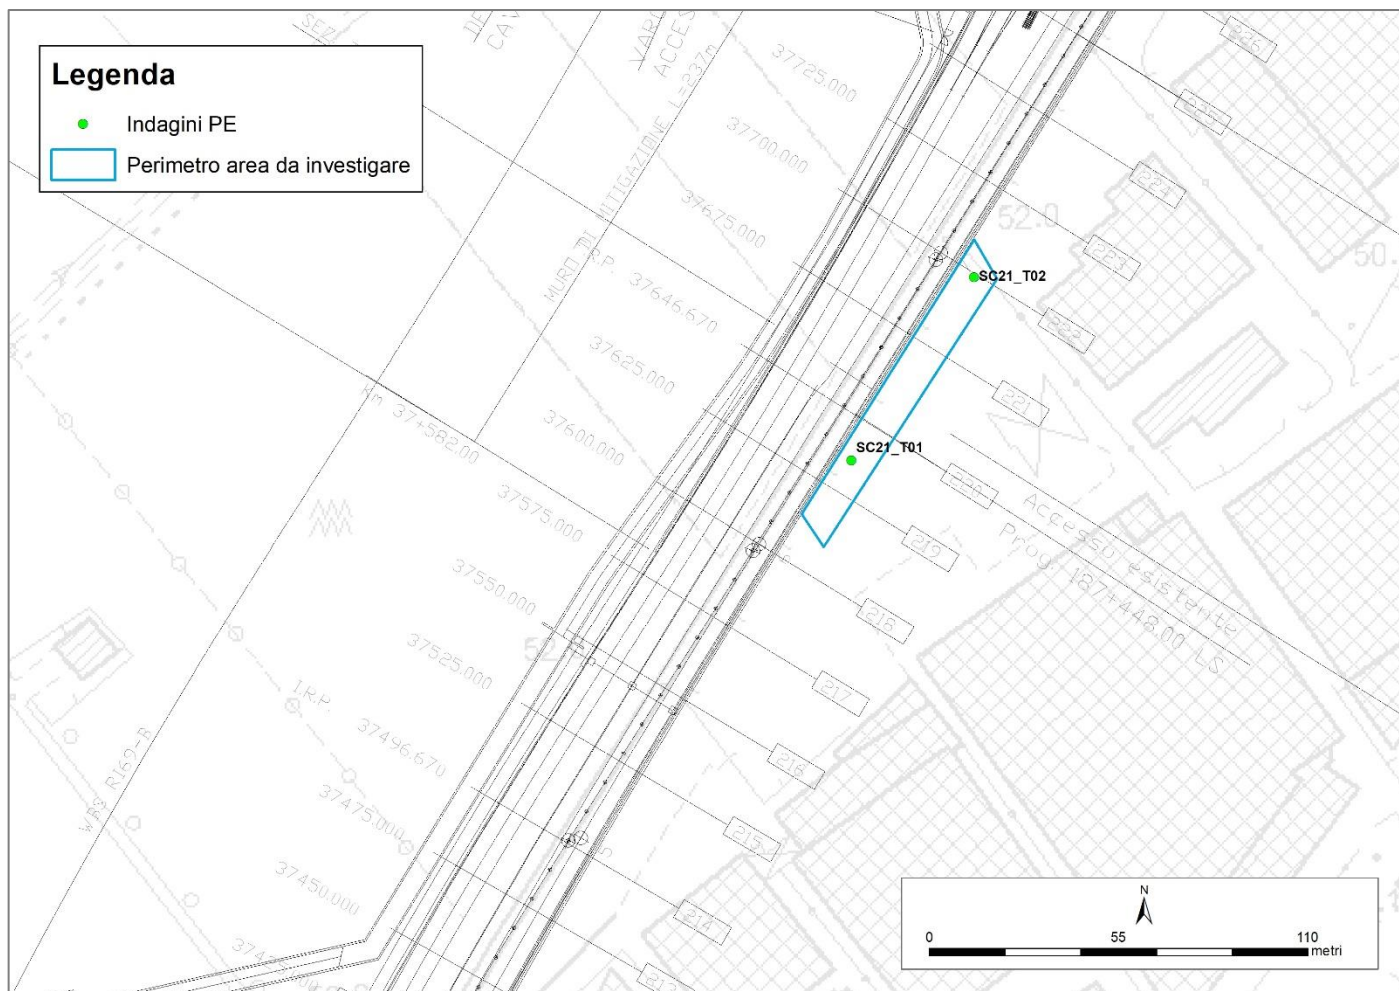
Perimetro dell'area di indagine su CTR con planimetria delle opere in progetto ed ubicazione delle indagini di PE.
